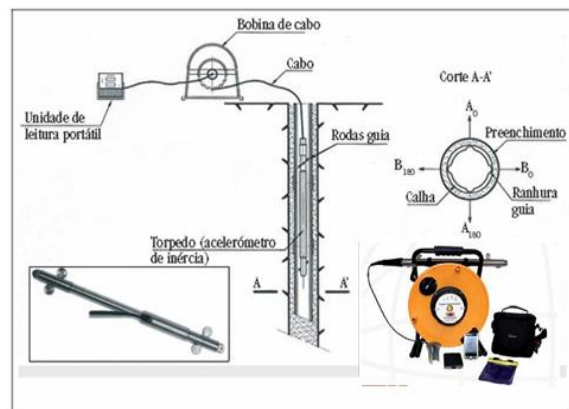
Esquema de implantação dos inclinómetros da estação.
